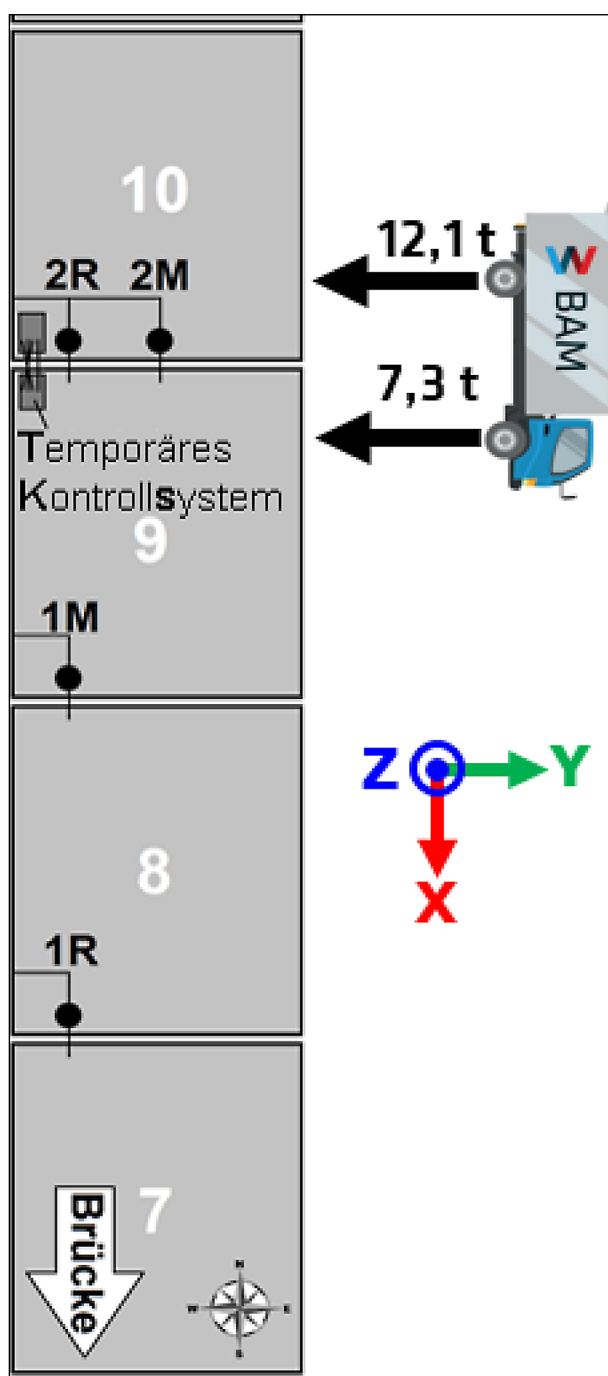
Lageplan der Sensorsysteme mit eingezeichnetem Lkw und Achslasten
